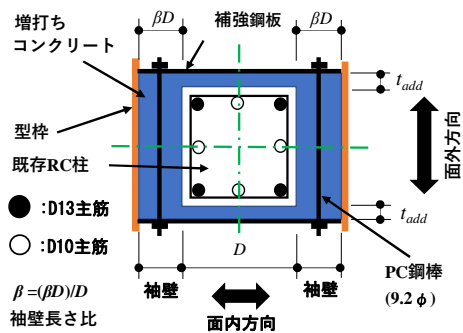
鋼板サンドイッチ工法により補強した既存 RC 柱断面図
